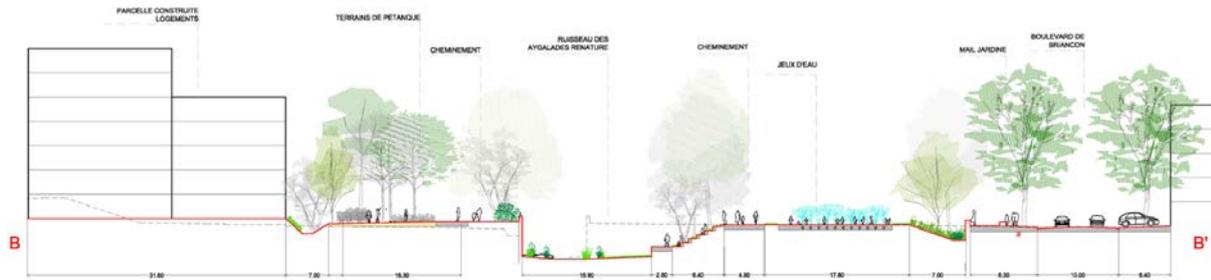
Coupe BB' du parc Bougainville (EPAEM)
